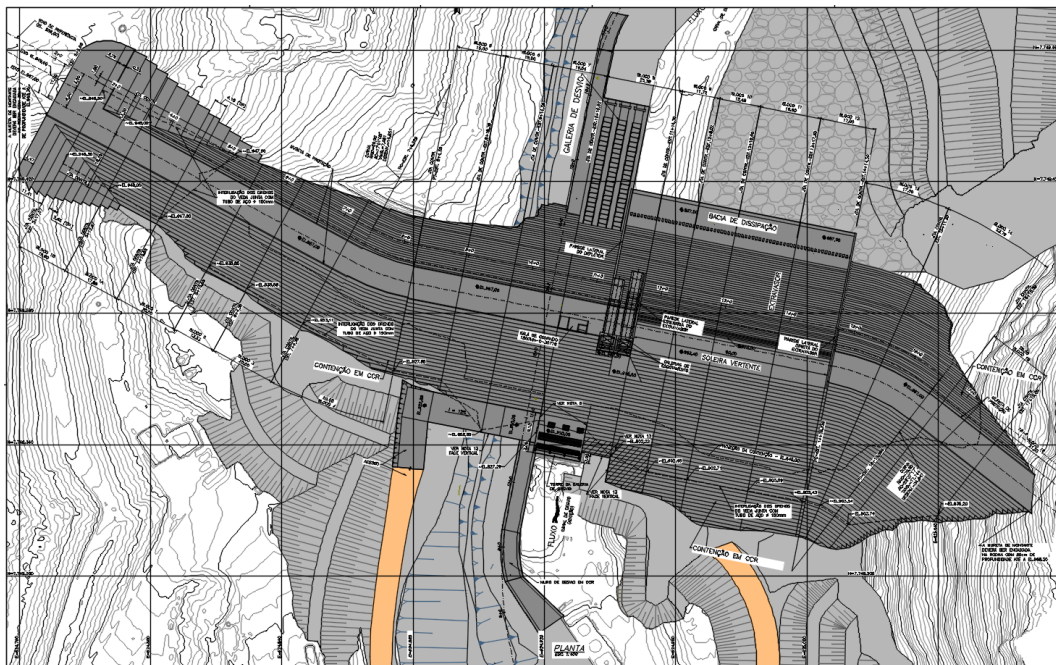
Planta da ECJ Fábrica (DF+, 2021)
